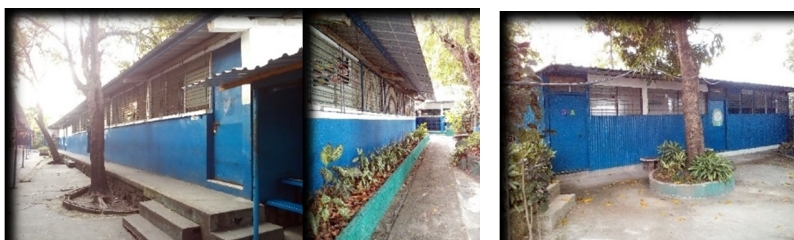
Fachada Sur y Norte del edificio "A" existente.
